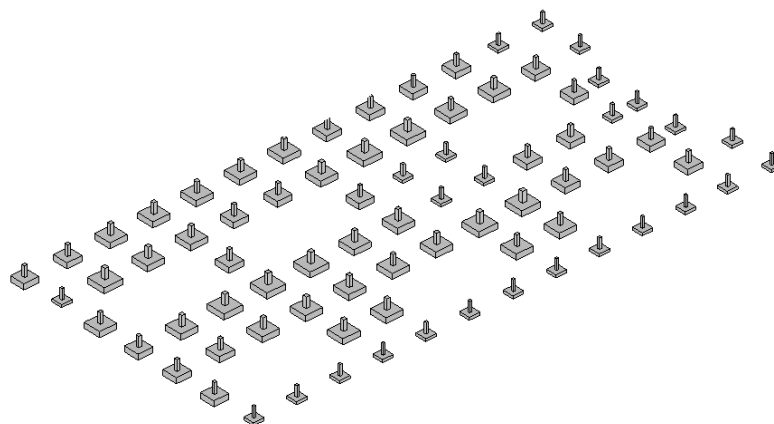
Vista tridimensional das sapatas dos pilares
